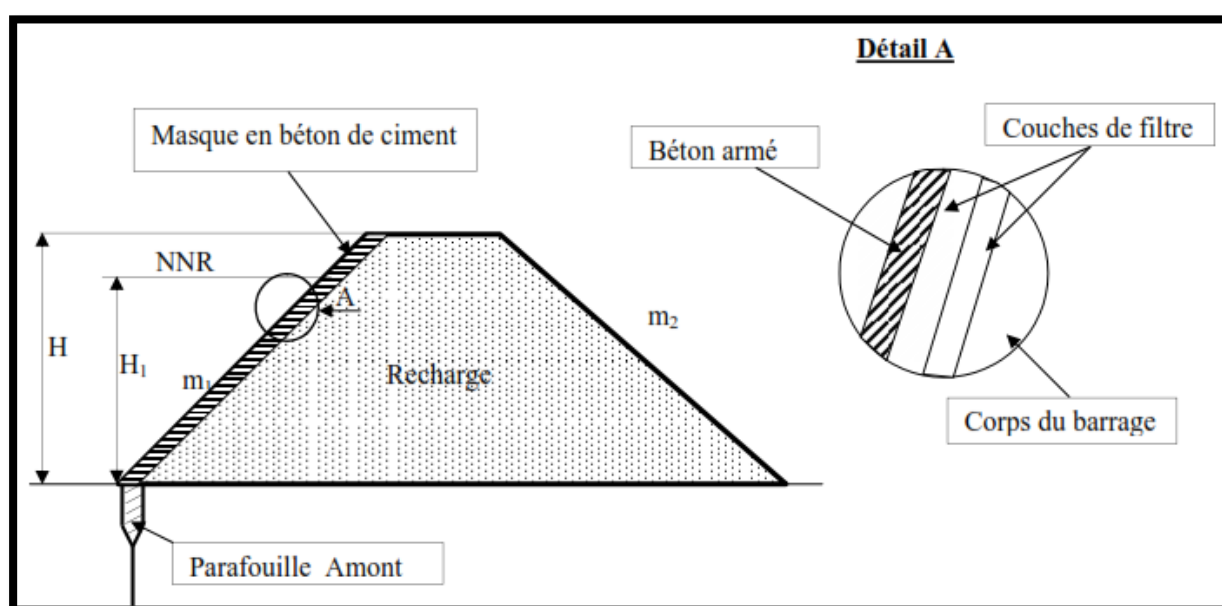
Coupe transversale d'une digue en enrochement avec masque en béton
